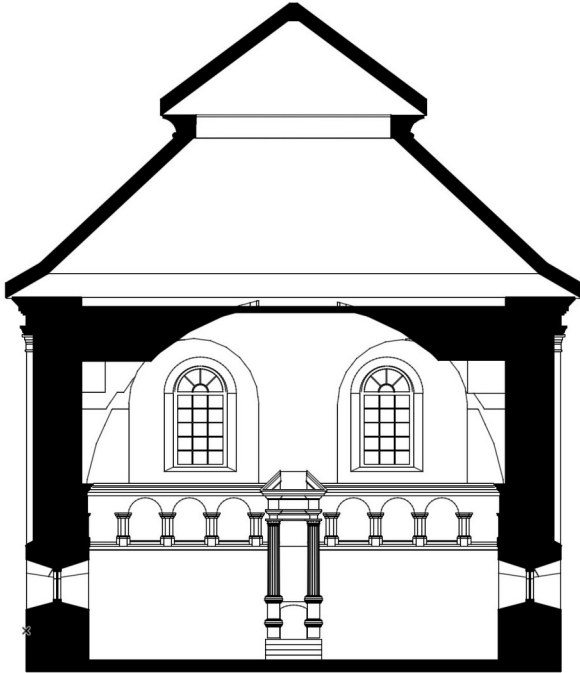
Nord/Süd-Schnitt Plandarstellung
